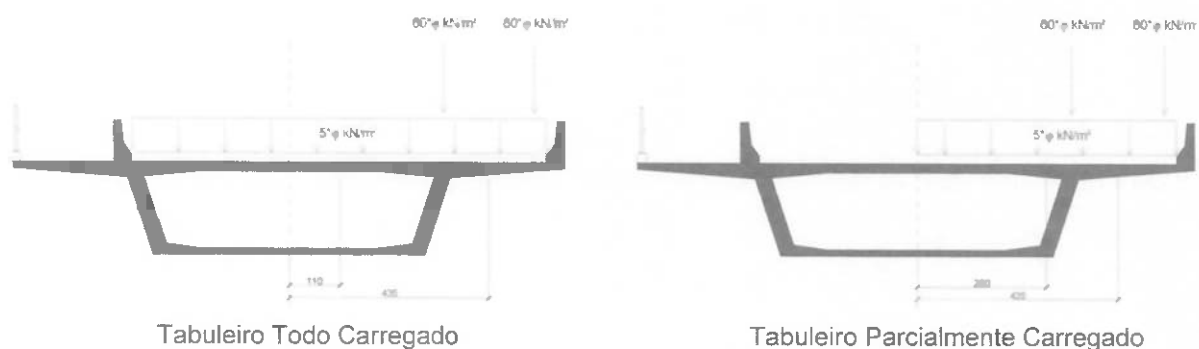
Carregamento Transversal para as Situações de Projeto
